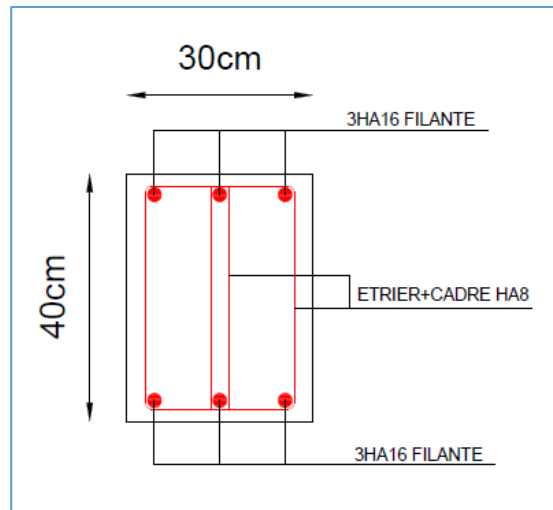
Ferrailage des poutres secondaires en travée.
